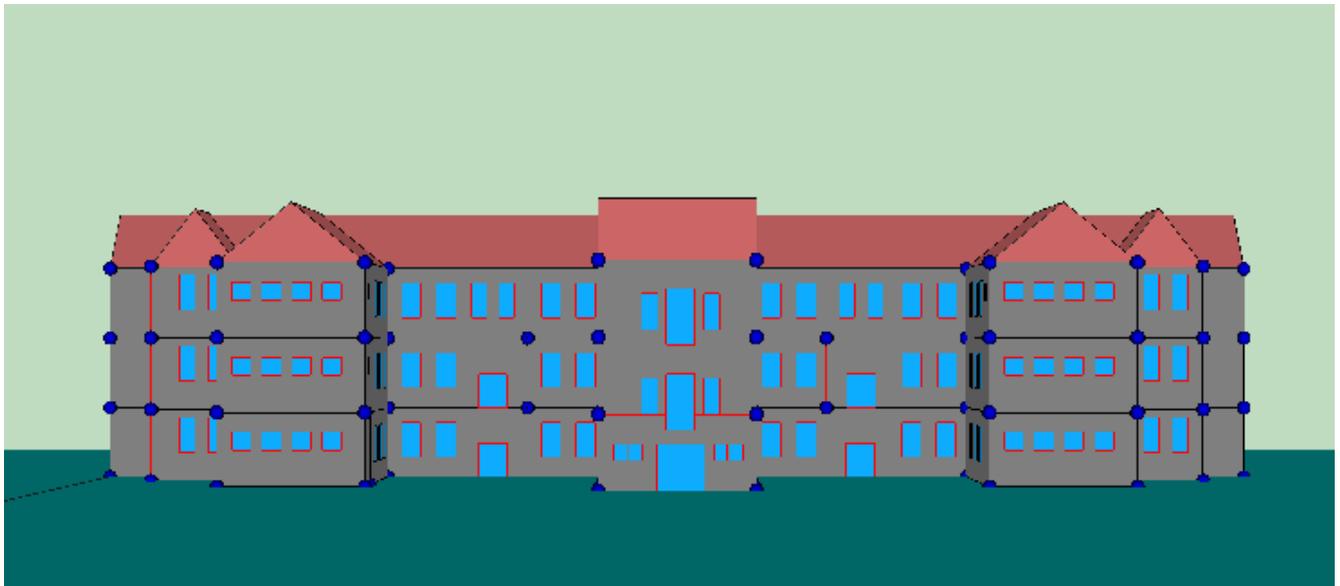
Fachada del cuartel con ventanas y tejado. Fuente CalenerVYP
